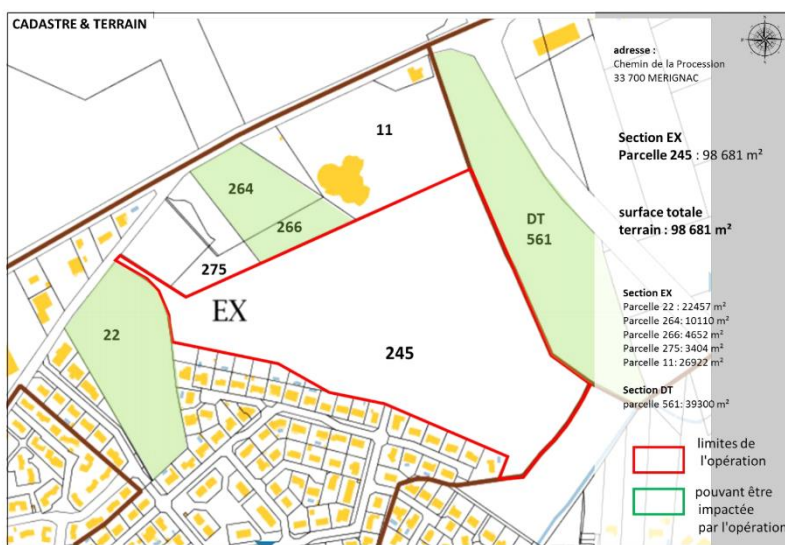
Plan parcellaire (Source : Programme fonctionnel de construction du collège – Mars 2020)
